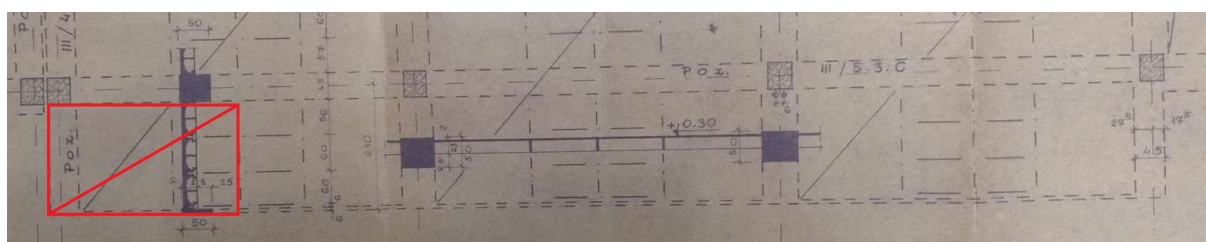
Przekrój przez wspornikową część stropodachu częściowo do usunięcia.
